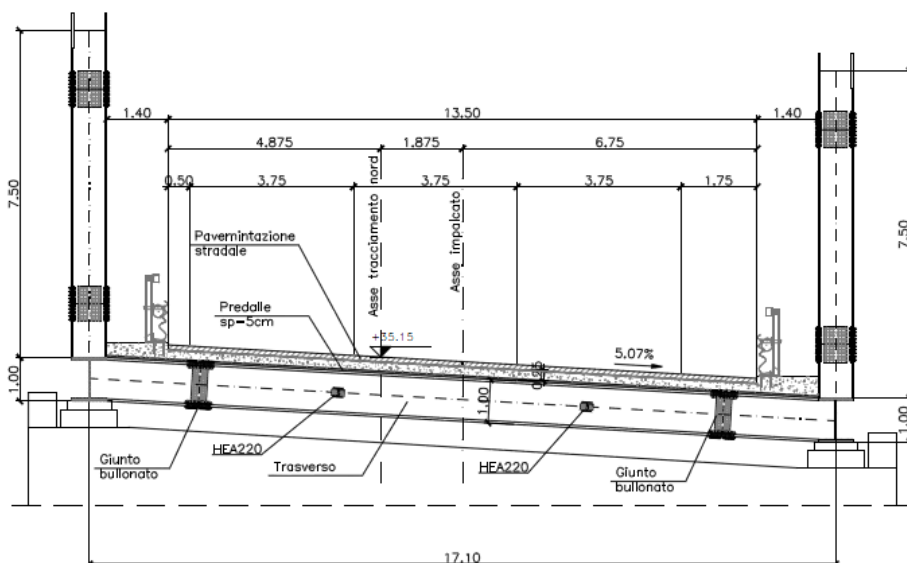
Sezione Spalla Viadotto Gerace
